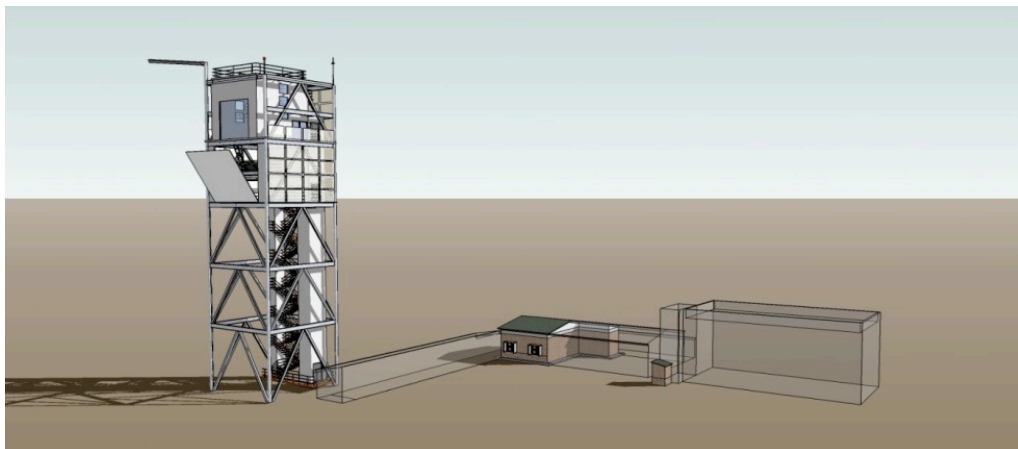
Proyecto arquitectónico del CPH, ilustrando las áreas que corresponden al proyecto LNCSQS. Las demás áreas están planeadas para el LNCSQS 2da Etapa.
